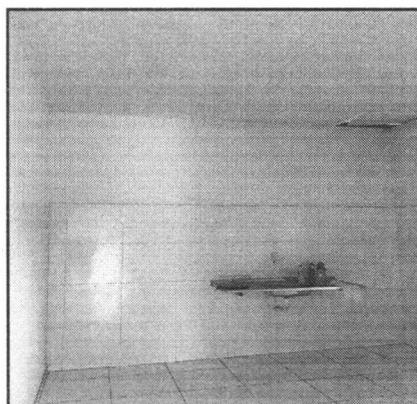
Vista da Cozinha com piso e paredes revestidas com cerâmica e forro em PVC
